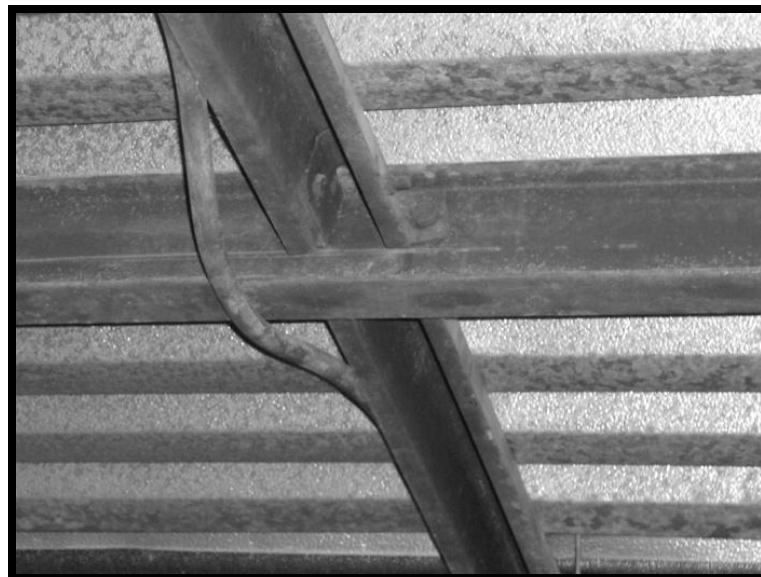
Edificación 2. Caso particular de uso de perfil metálico tipo IPN120 como columna de refuerzo. Columnas en el extremo Sur-Este de esta edificación, y apreciadas hacia la parte externa de dicha fachada.
